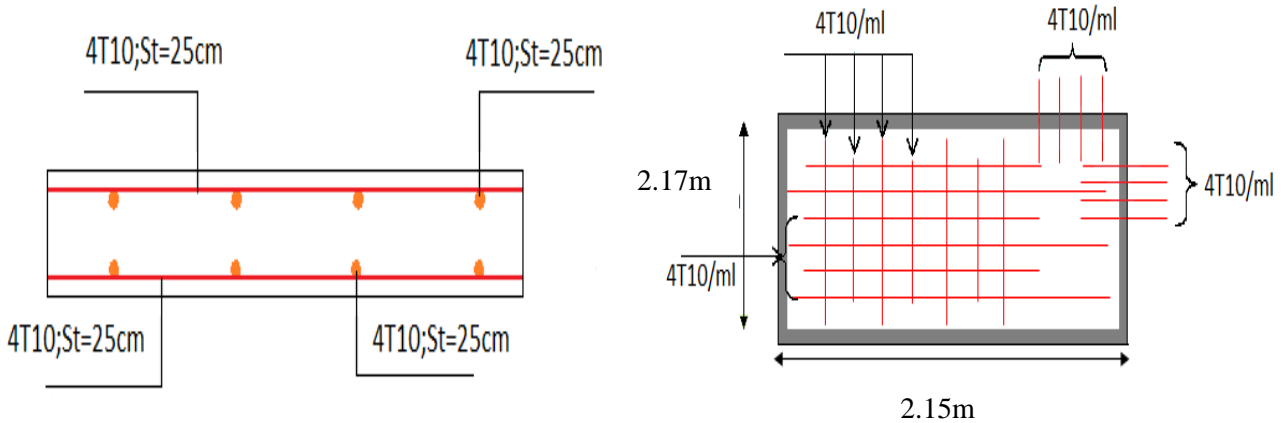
Sch\u00e9ma de ferrailage de la dalle d'ascenseur.
